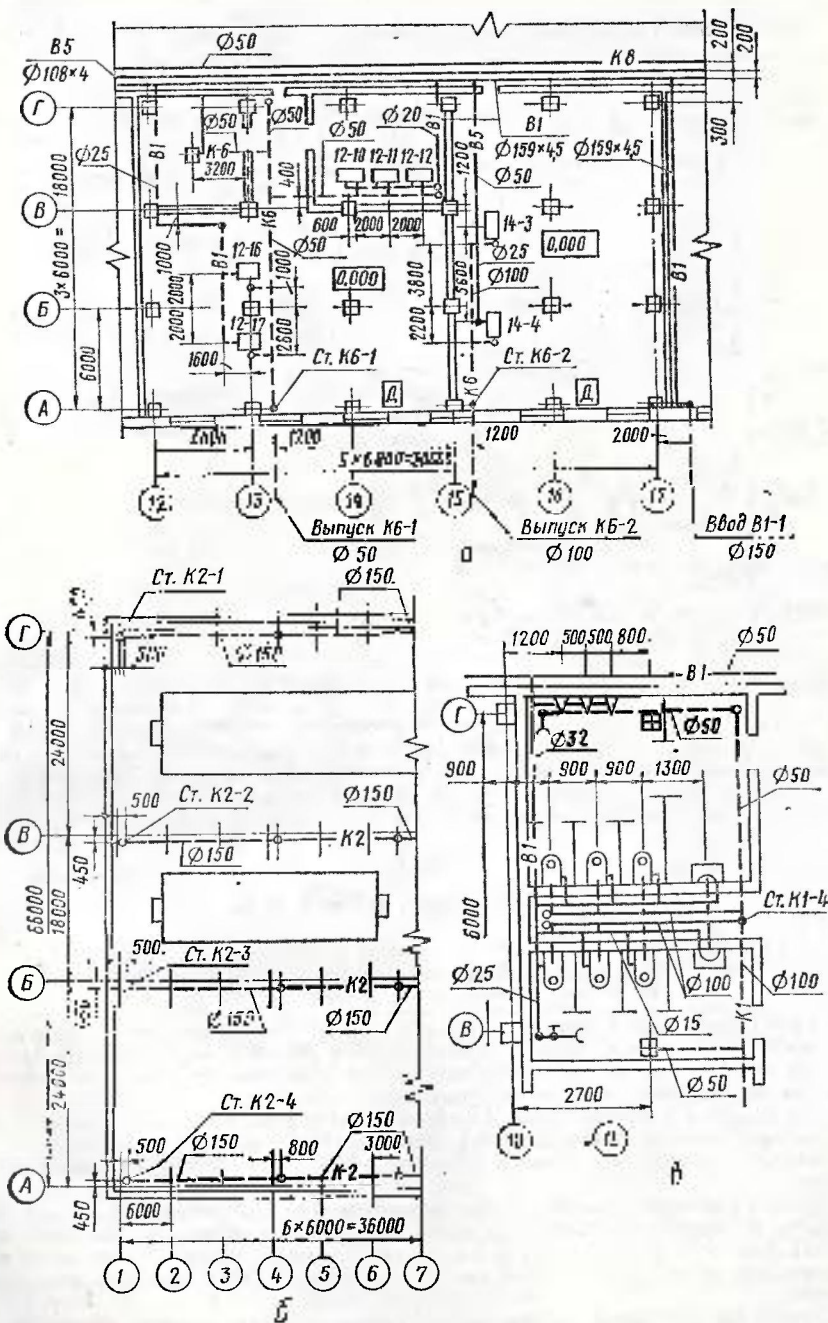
Пример оформления планов систем водопровода и канализации: а — план на отм. 0,000; б — план кровли; в — фрагмент плана.
